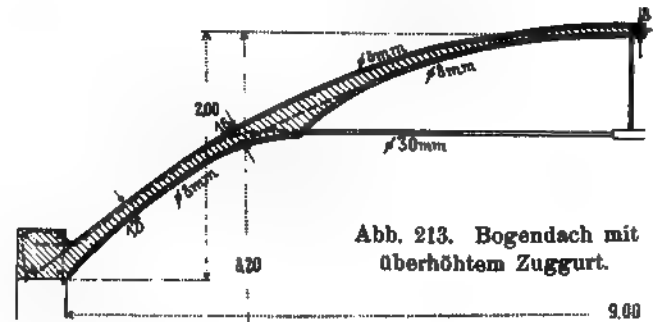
Bogendach mit überhöhtem Zuggurt.
